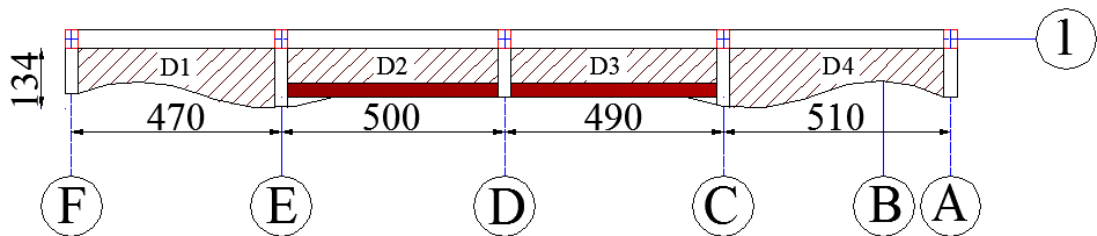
représentation des panneaux de dalle D1, D2, D3 et D4.
